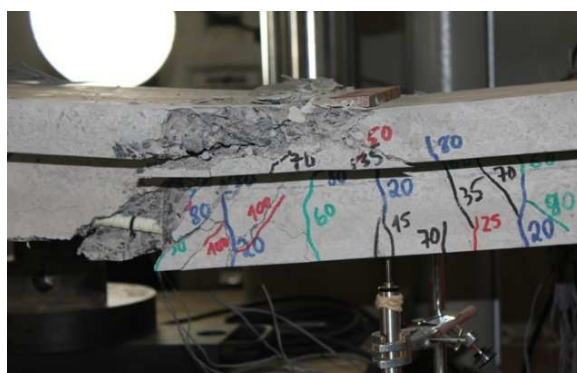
Rotura por esmagamento do betão no vão da viga G3-b
